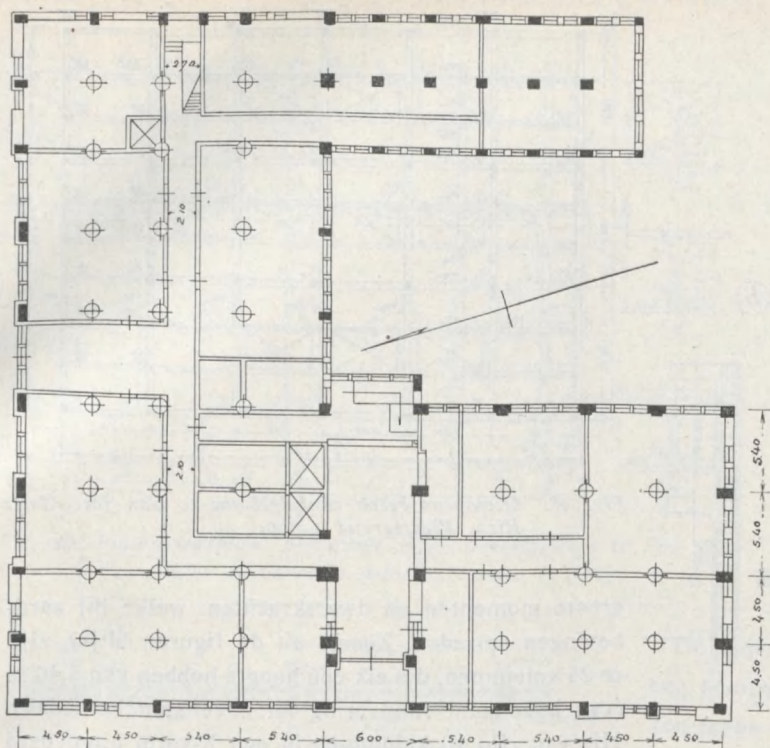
Plattegrond 8ste verdieping (1:500) van het N a i g a i-gebouw. De vulwanden tusschen het gewapend beton skelet waren van baksteen en gaven het gebouw onvoldoende stijfheid.
